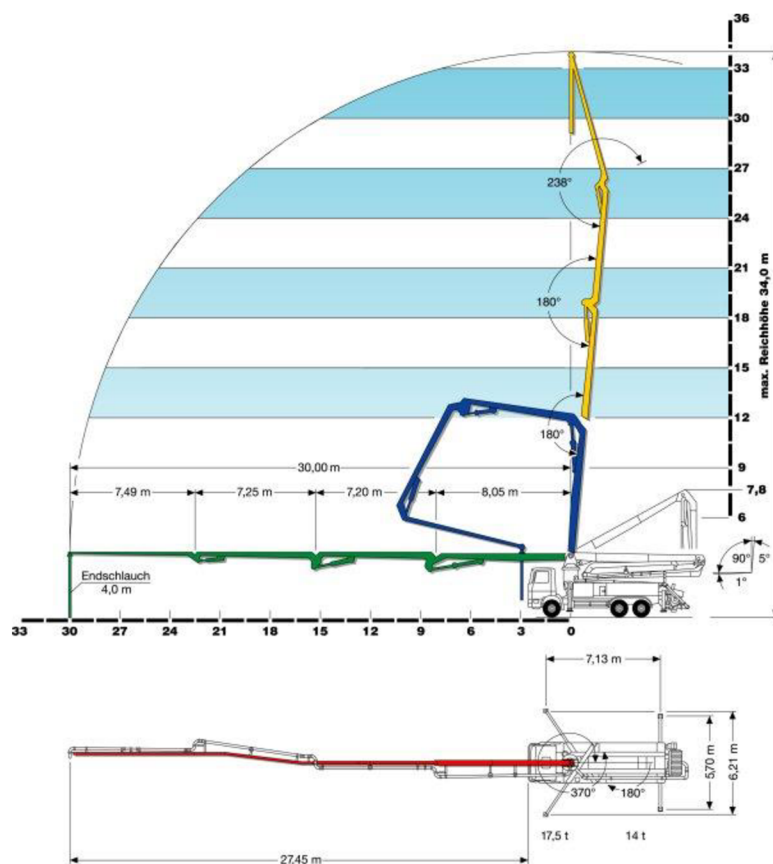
Autočerpadlo SCHWING S34X
